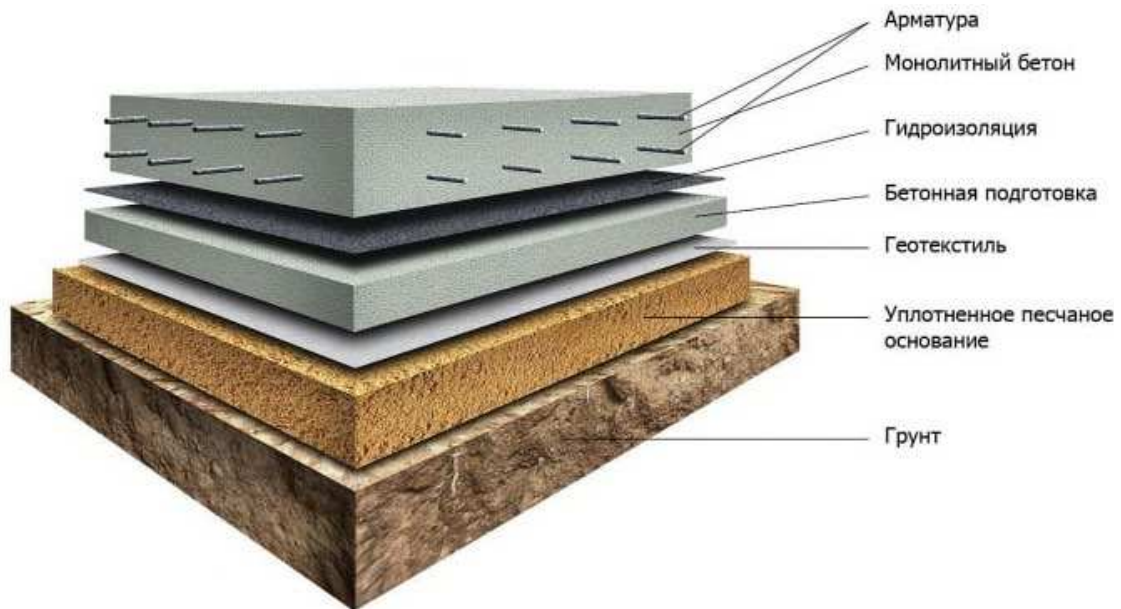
Пошарове укладання монолітного залізобетонного фундаменту
